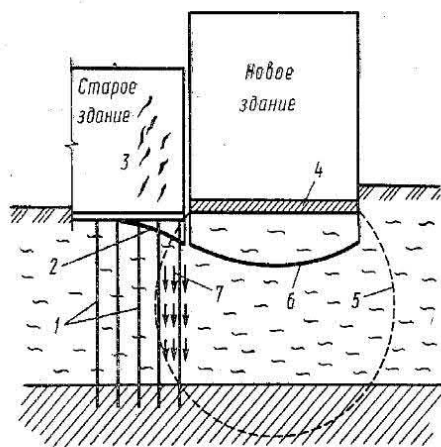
Строительство нового здания с другим типом фундамента:
